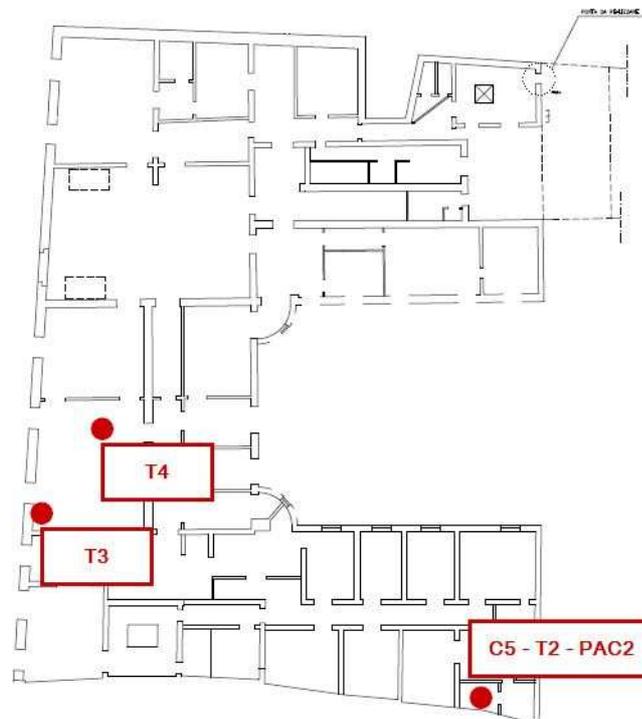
Estratto planimetria piano interrato. In rosso i punti di prova
